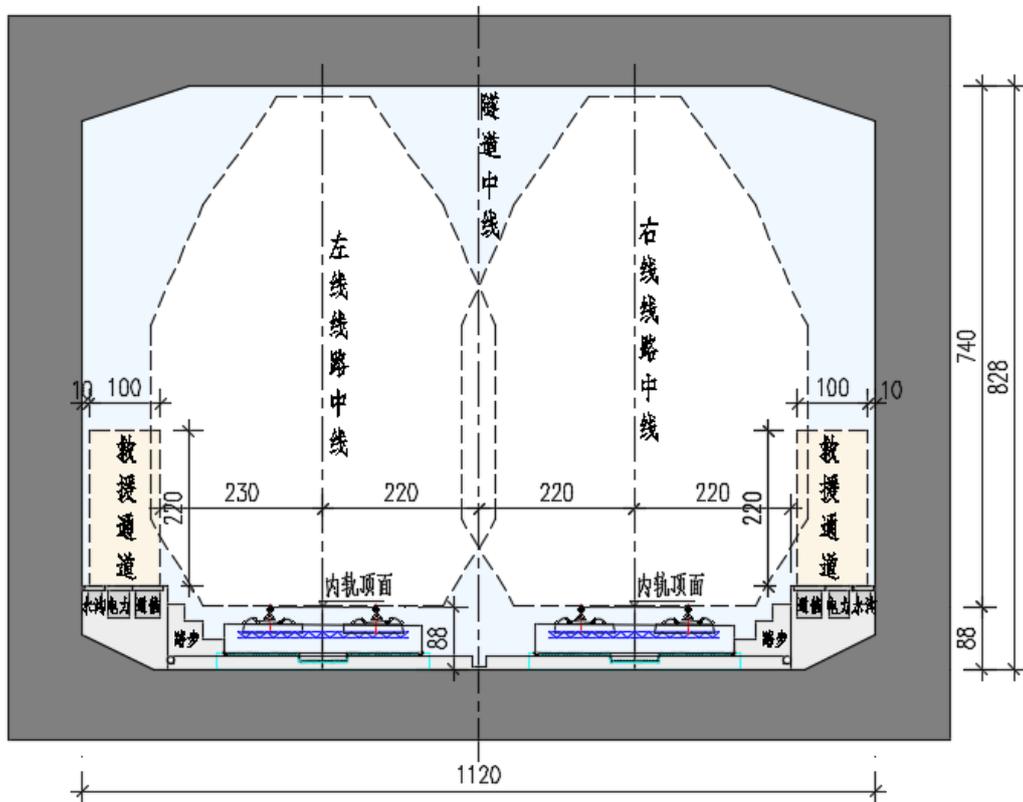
一般地段框架隧道横断面 (单位: cm)
